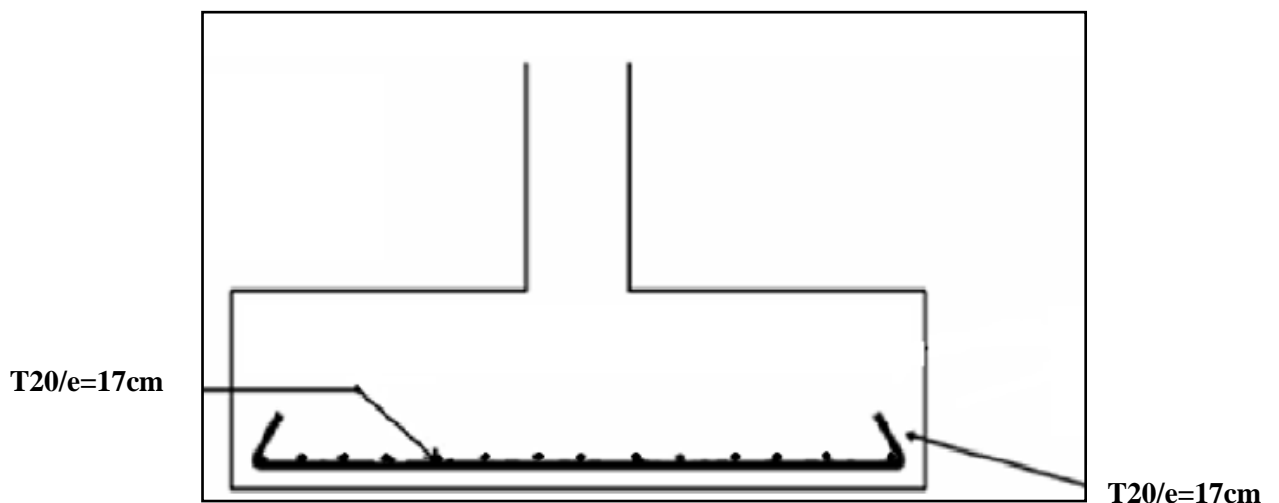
Ferrailage de la semelle filante sous le voile délimité par les axes B et C.
